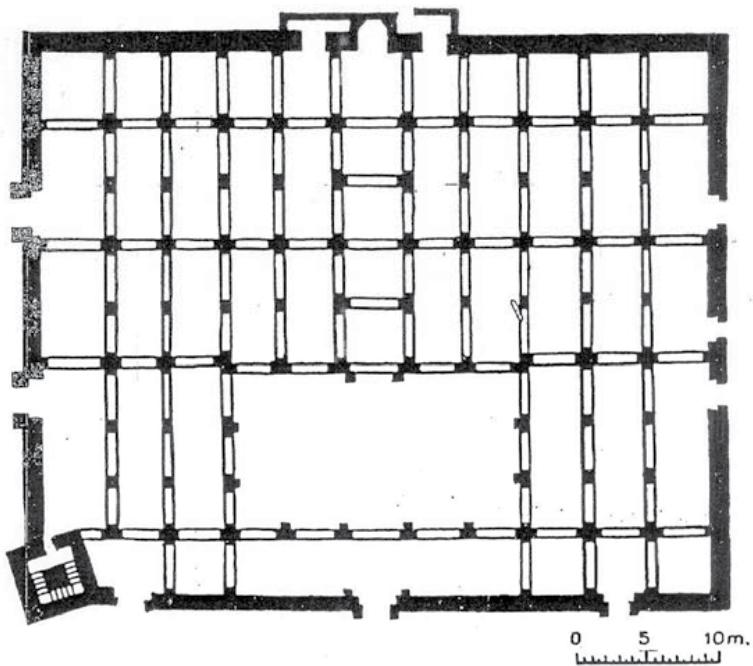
جامع الأندلسيين، مسقط أفقي، عن:
